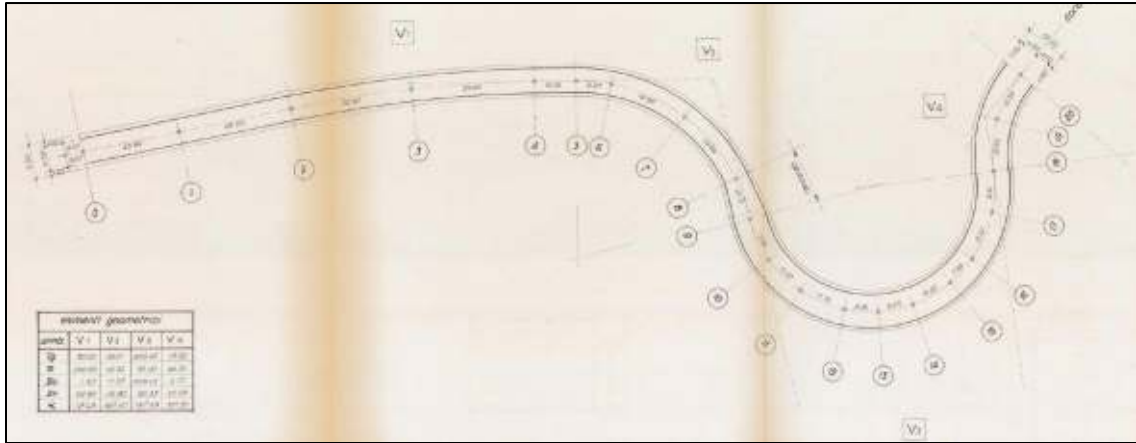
Strada di accesso al coronamento – Planimetria del tratto di strada che congiunge la spalla sinistra dello sbarramento al piazzale della casa di guardia.
